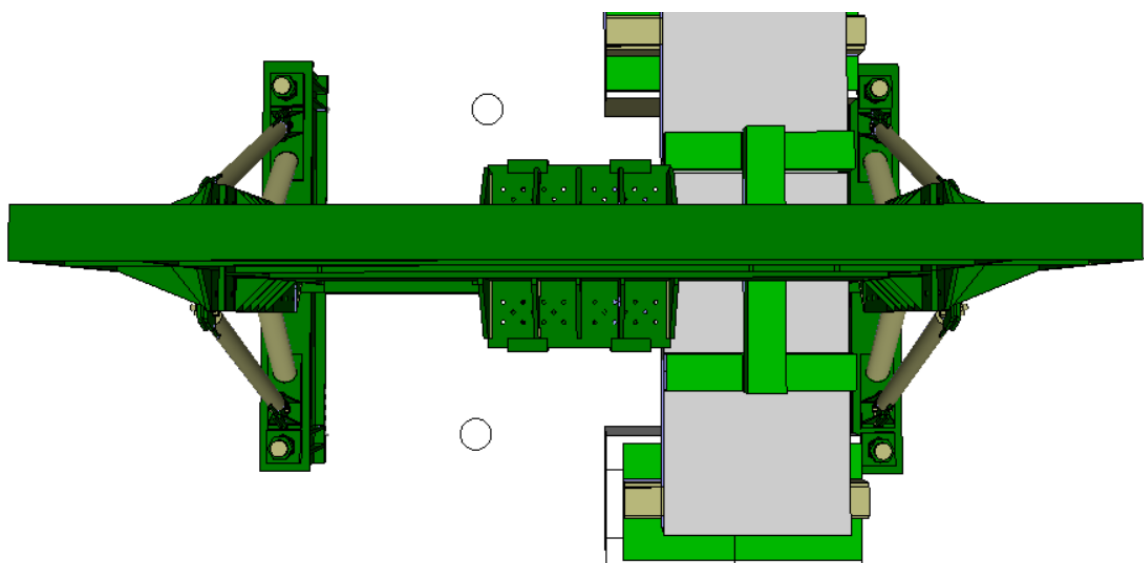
Vista superior do pórtico para ensaio das lajes.
